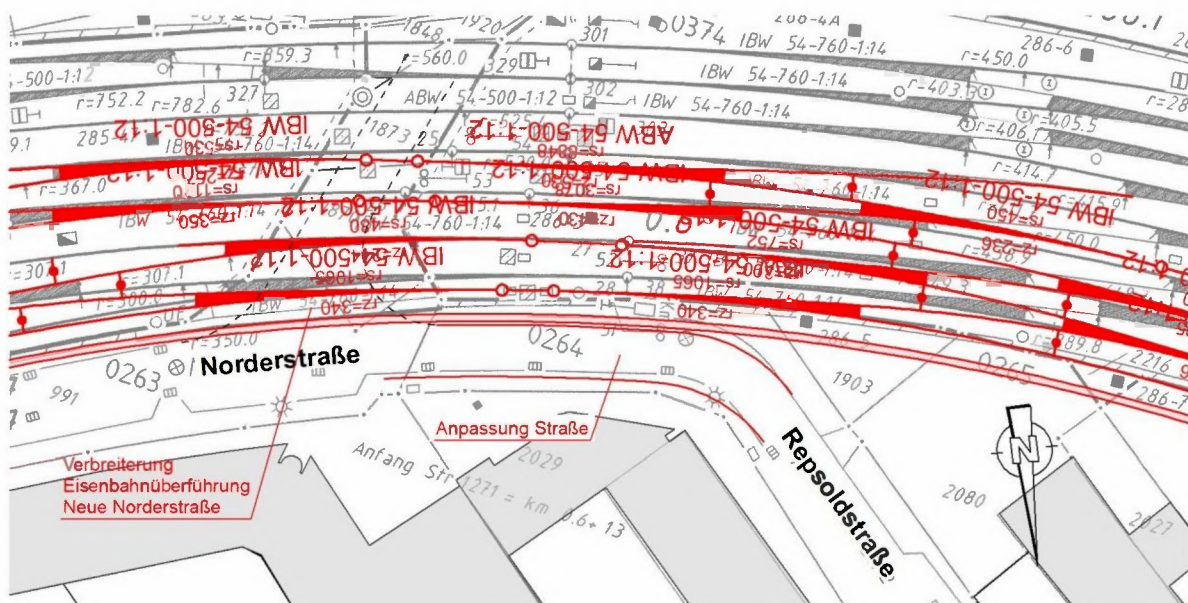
Lageplan Variante 2 Bereich Repsoldstraße/Norderstraße
